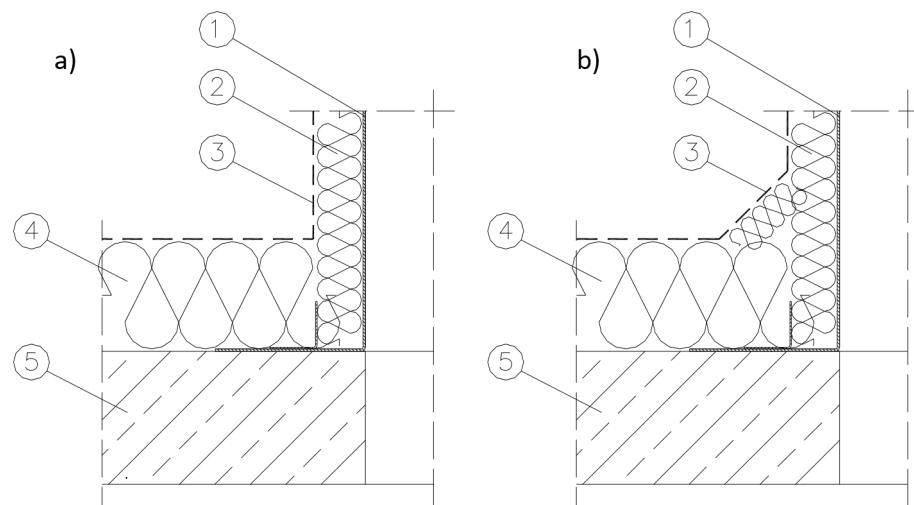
Стальное основание на железобетонной плите (а – обработка мембраной, б – обработка рубероидом)
